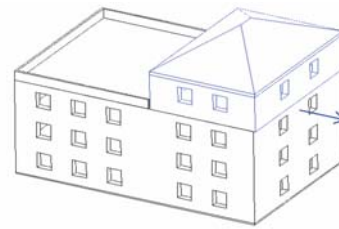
Schadenstyp P8: Gleiten des Dachgeschosses
